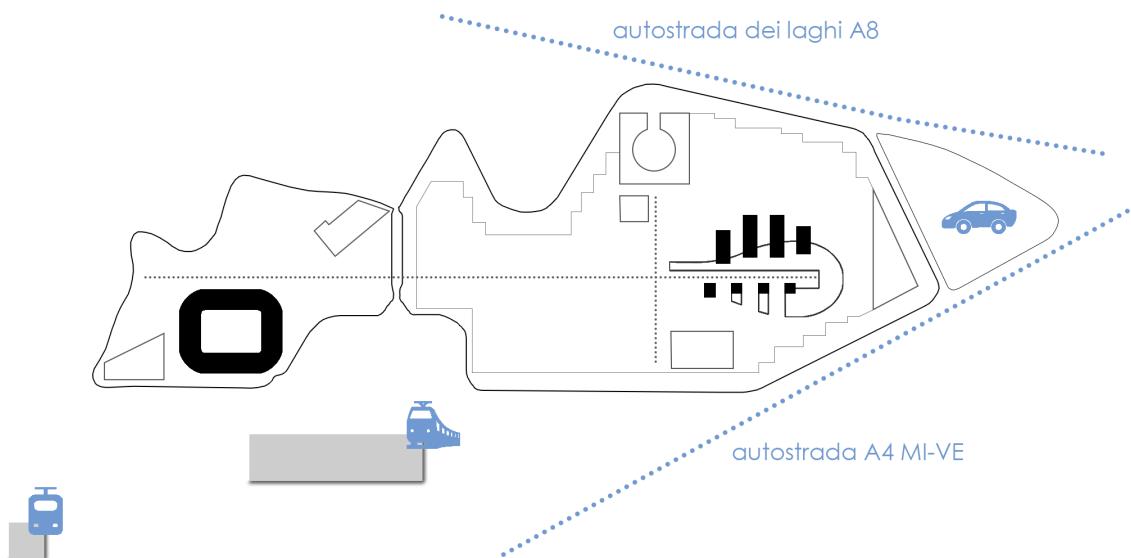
Schema diagramma posizionamento Stadio e CdSR di progetto
